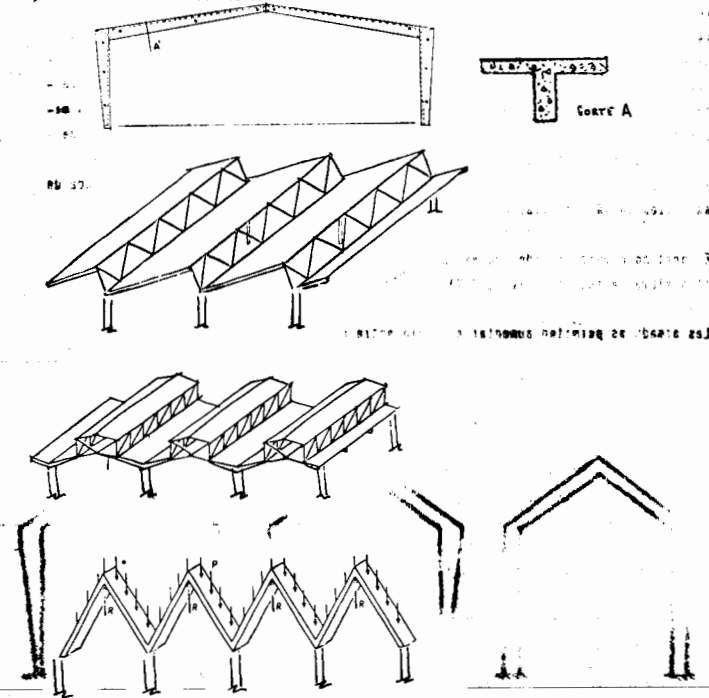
Sistemas de cubierta con vigas o armaduras.
